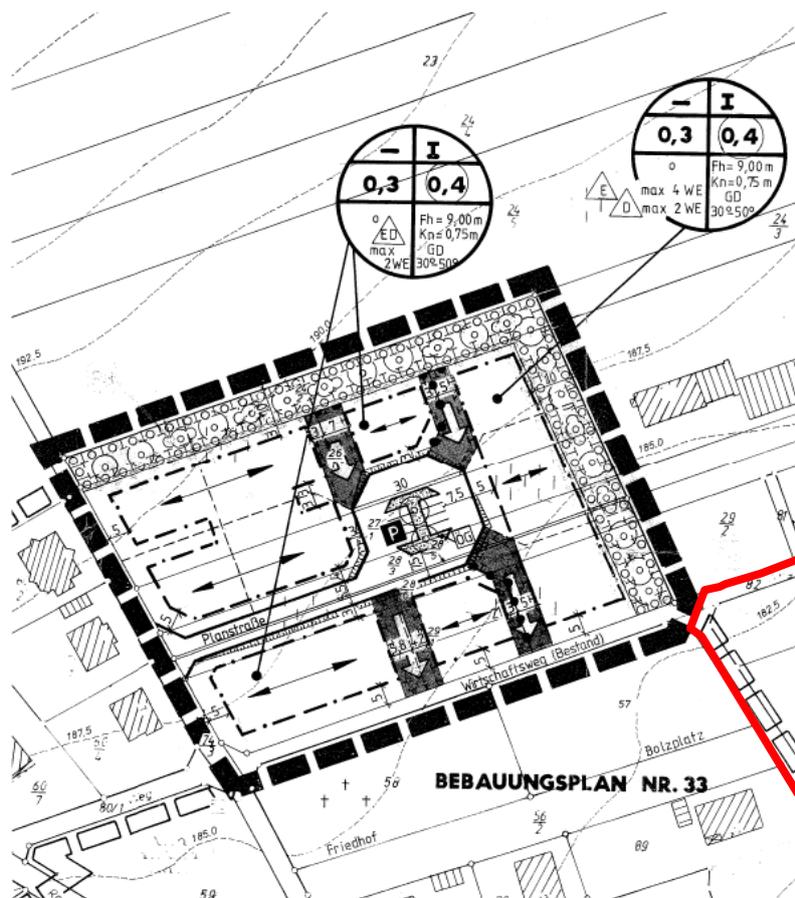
Bebauungsplan "Nr. 33c Nördlich des Friedhofs Schafhausen"
